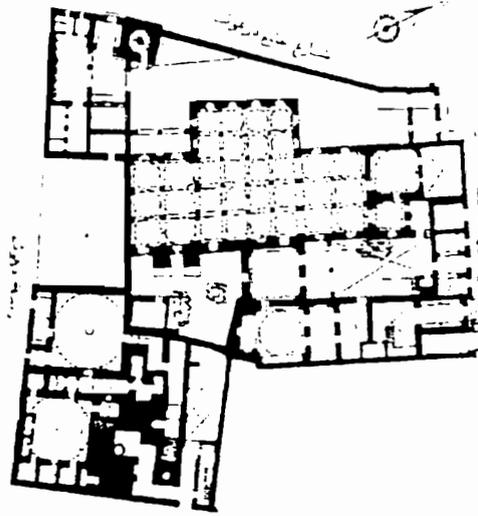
مسقط أفقي لجامع سالم المشاط عن الموسوعة (الجزء الأول).
